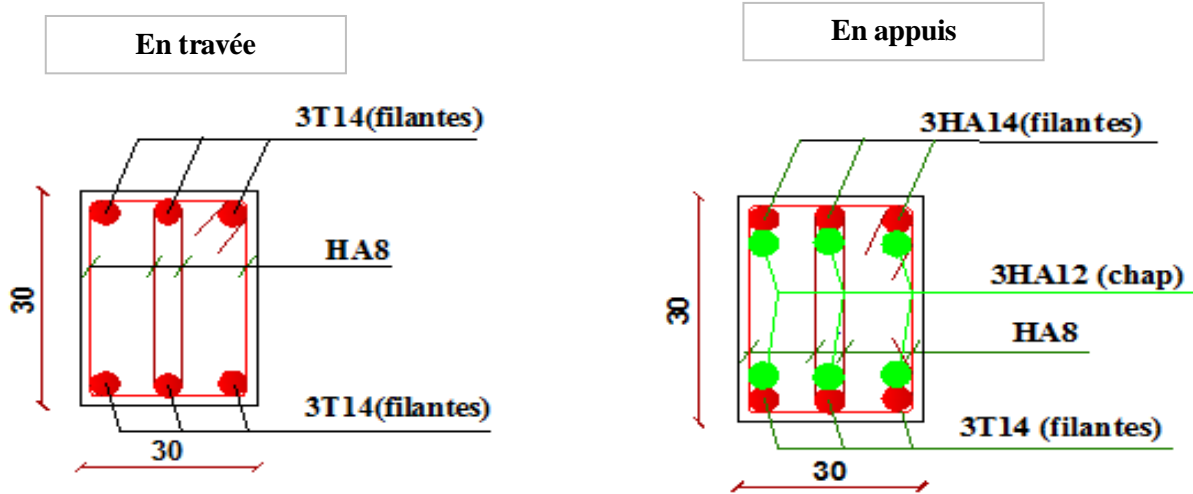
Ferrailage des éléments poutres principales de la structure auto- stable
